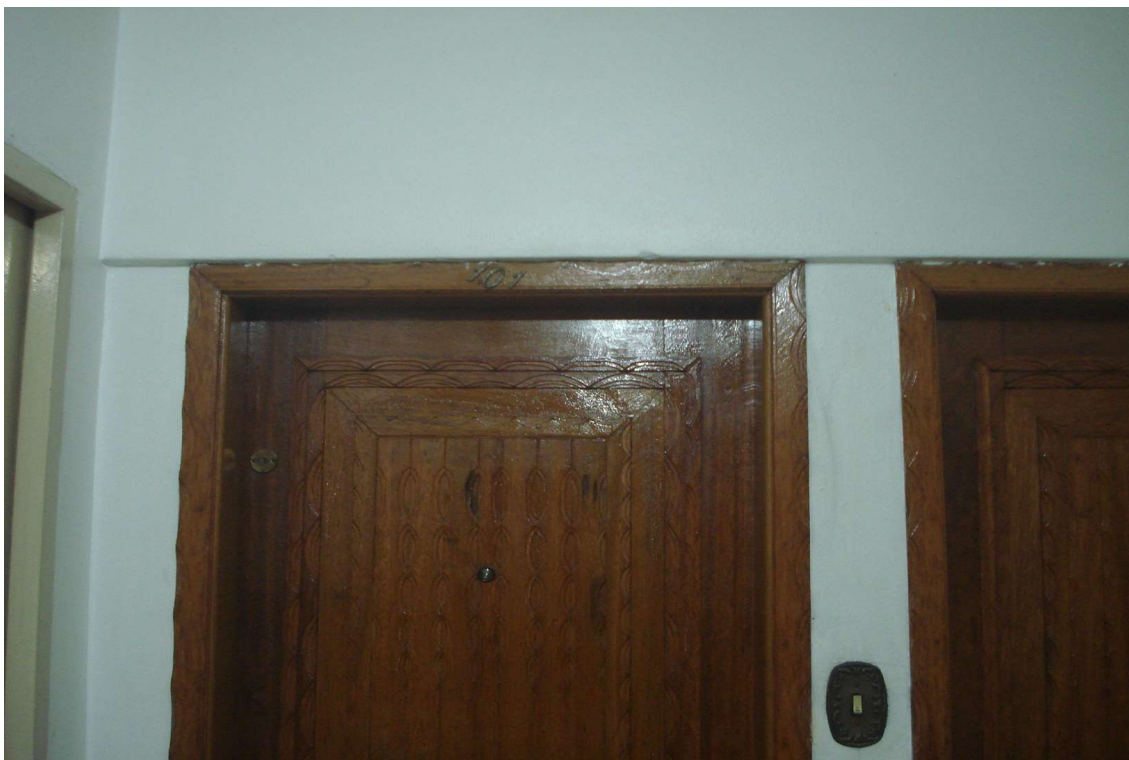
Vista da porta de entrada apartamento paradigma.
